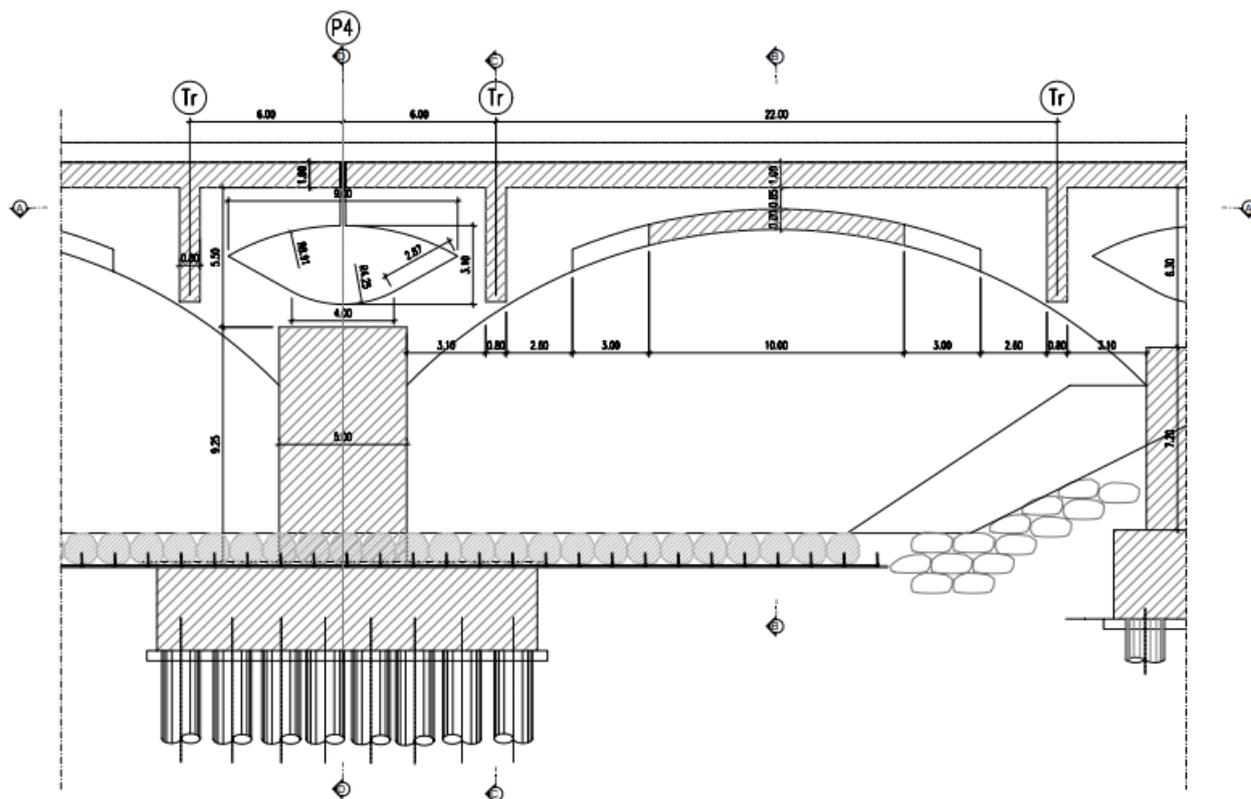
Sezione longitudinale di pila e campata in alveo
